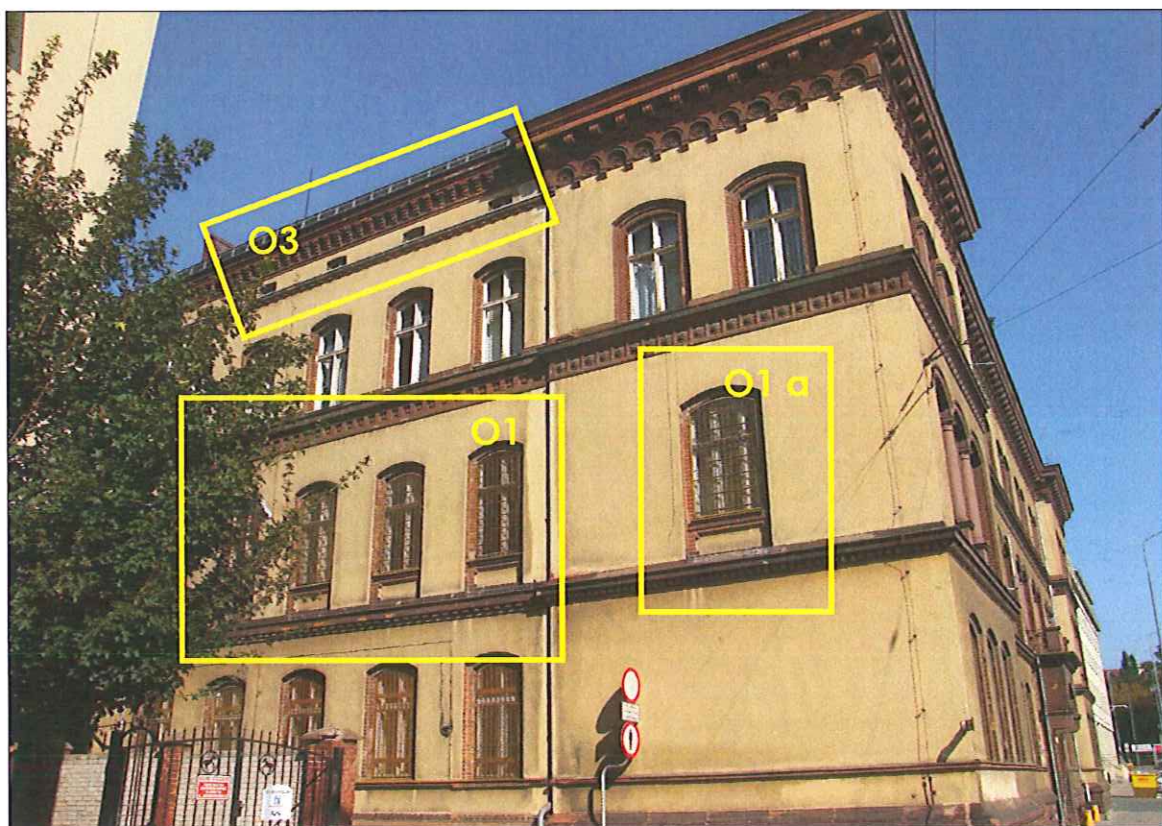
Elewacja wschodnia – przykładowa lokalizacja typów okien.....	15
